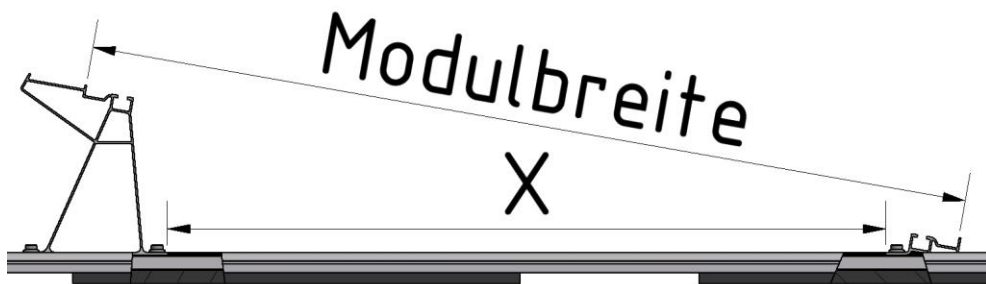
AeroFix 10-S „Stütze oben“ mit Abstand „x“ mit 2 Schrauben M8x16 mit der Bodenschiene verschrauben
